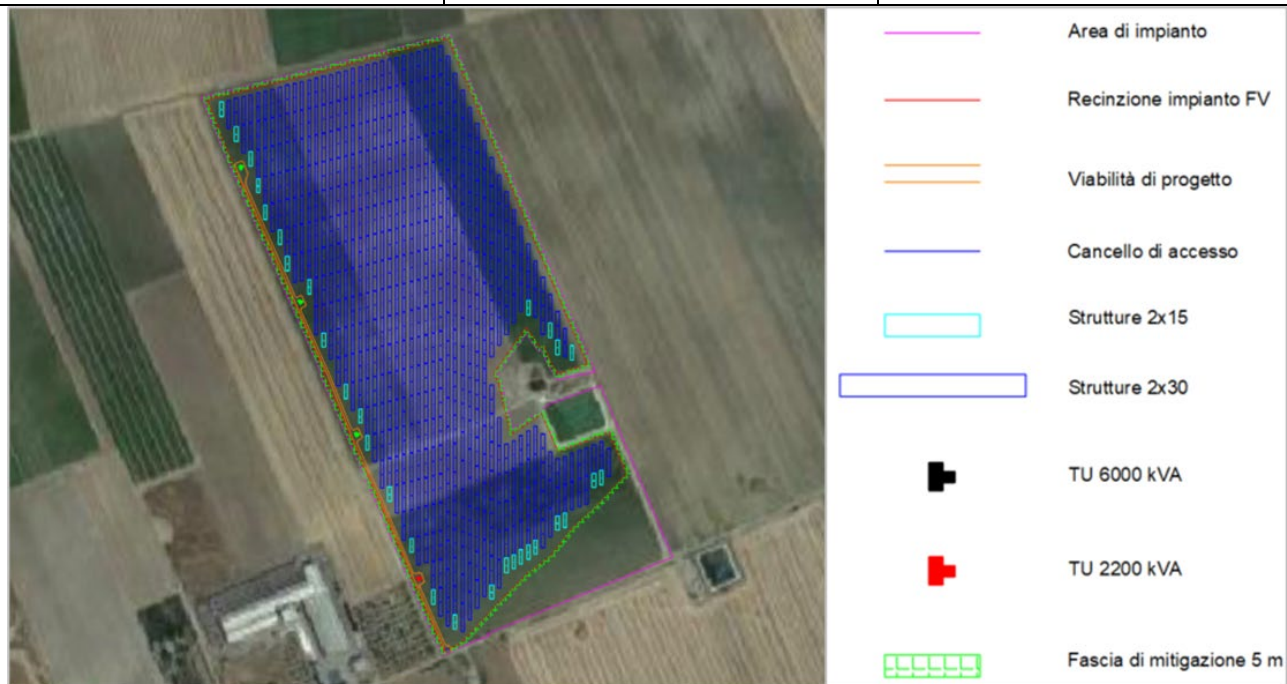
Sovrapposizione su ortofoto del layout di impianto - Lotto 2
